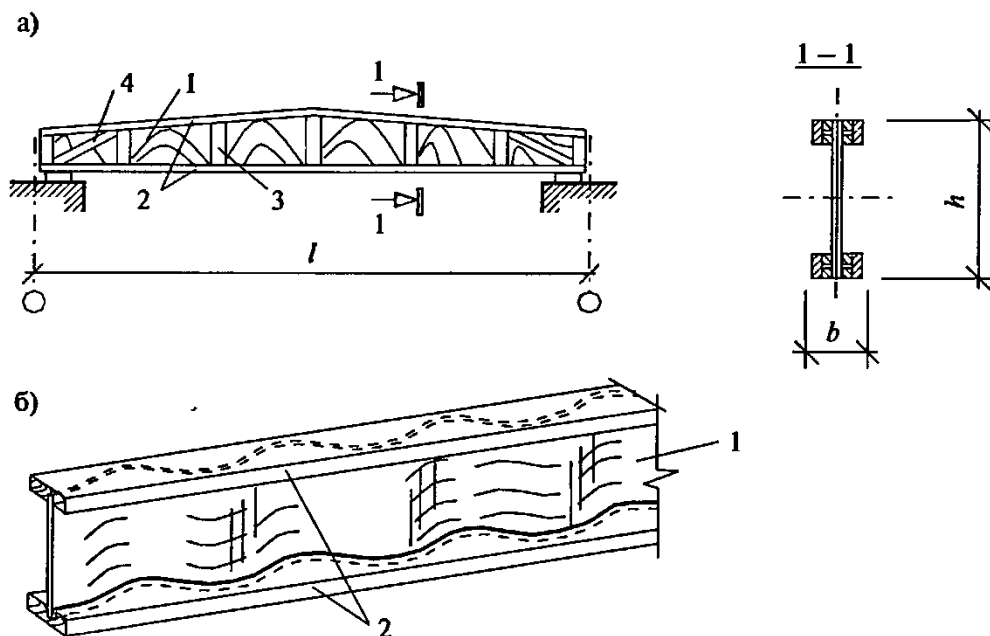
Балки с фанерными стенками: а) клееная балка с плоской фанерной стенкой; б) балка с гофрированной стенкой из фанеры; 1 – фанерная стенка; 2 – пояса балки; 3 – ребра жесткости; 4 – опорный подкос
